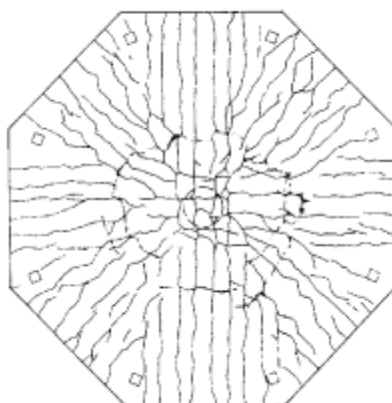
ETAPA 2: SURGIMENTO DAS FISSURAS TANGENCIAIS NA PEÇA
